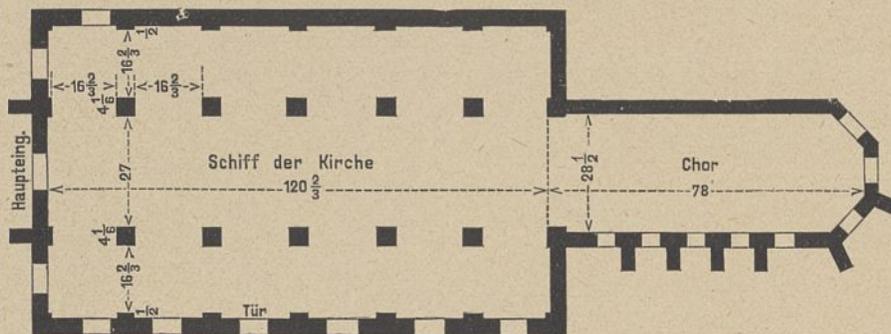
Ehemalige Barfüßerkirche, Grundriß.
